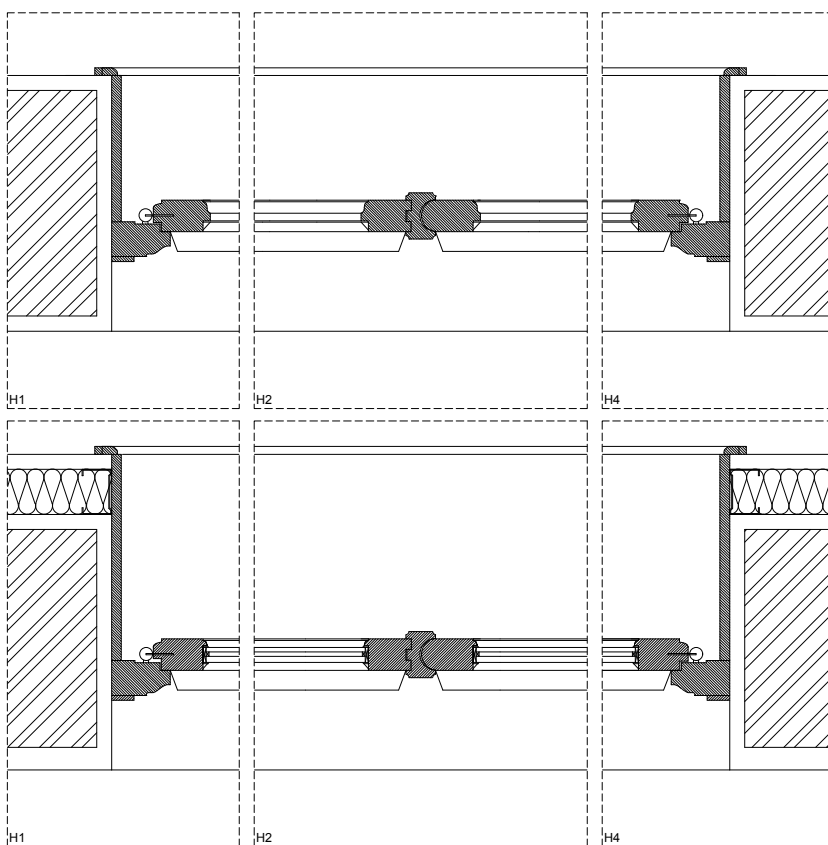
VE3 | Levantamento e proposta | Planta | Escala 1.10
